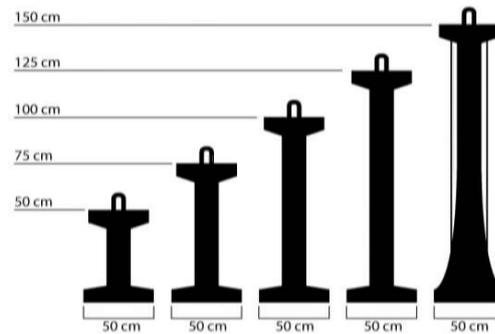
Seções transversais padrões das vigas pré-fabricadas pela Premag®. Disponível em: < <http://www.premag.com.br> >
